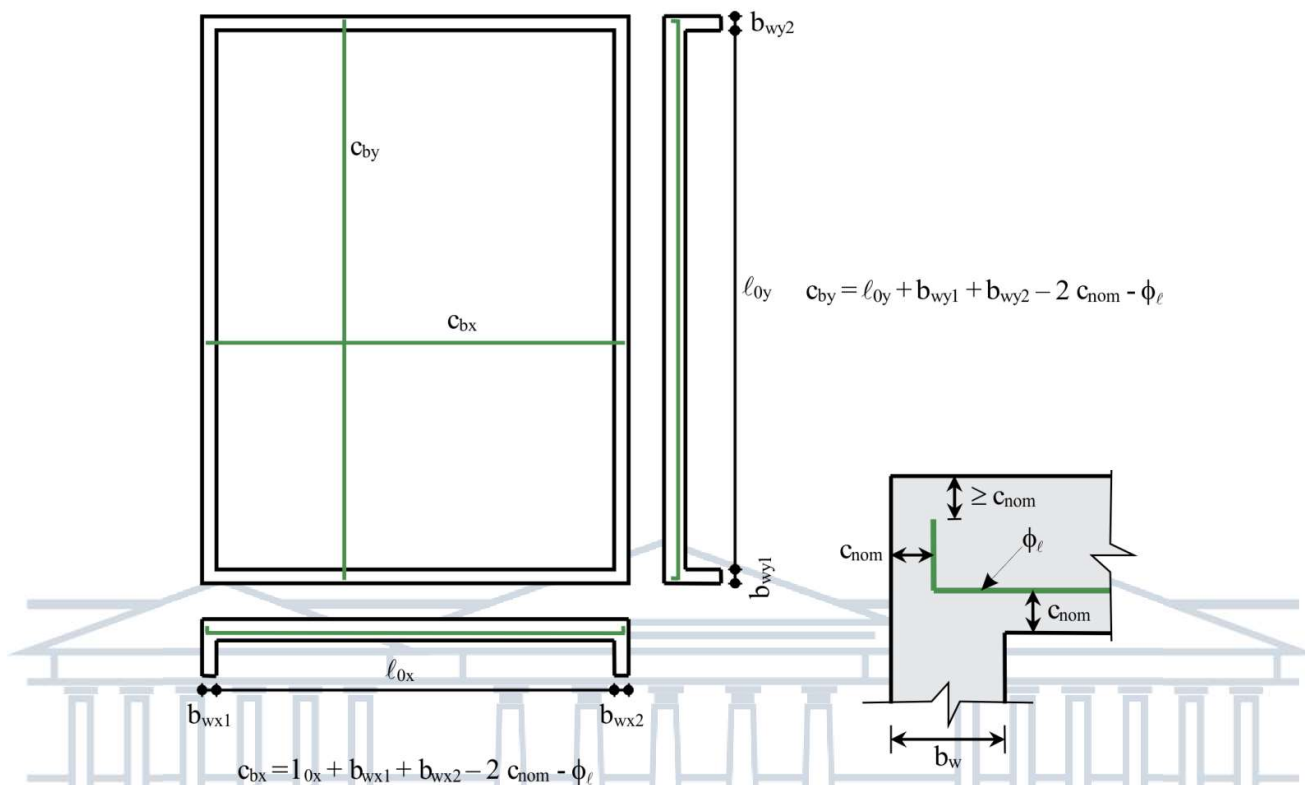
Comprimento de barras não alternadas – armadura positiva
